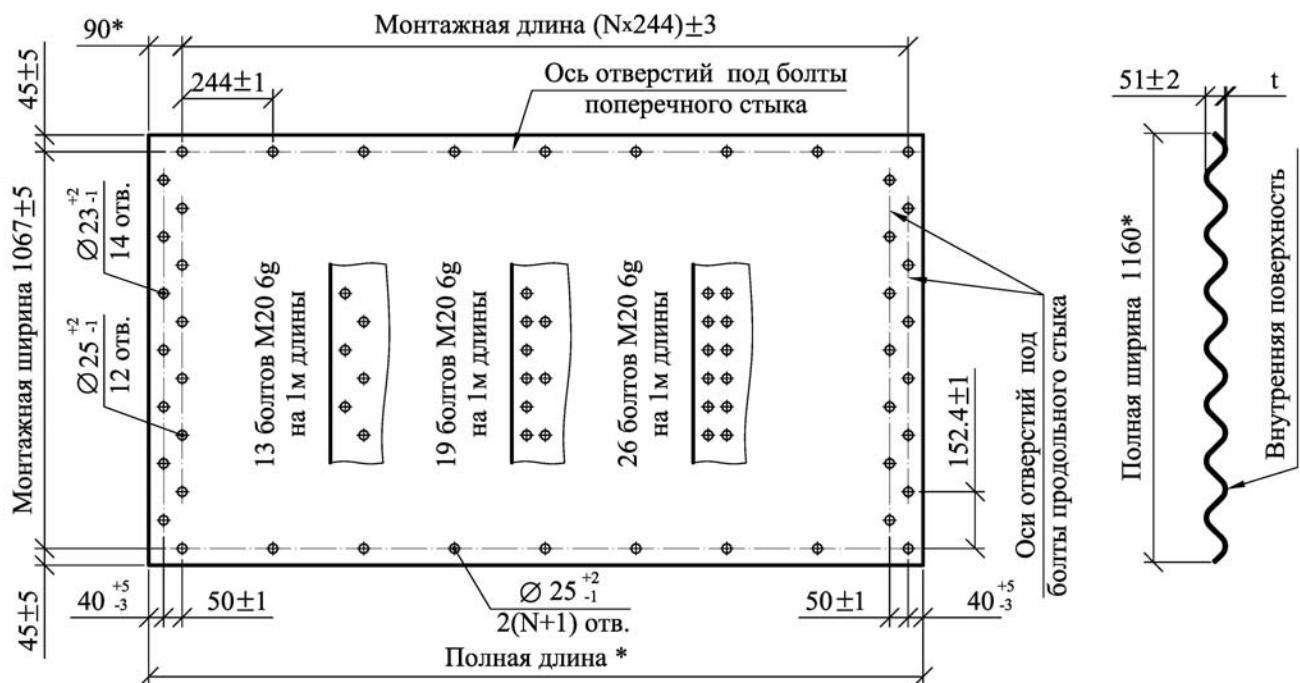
Гофрированный стальной лист ГЛ50. Вид и размеры
